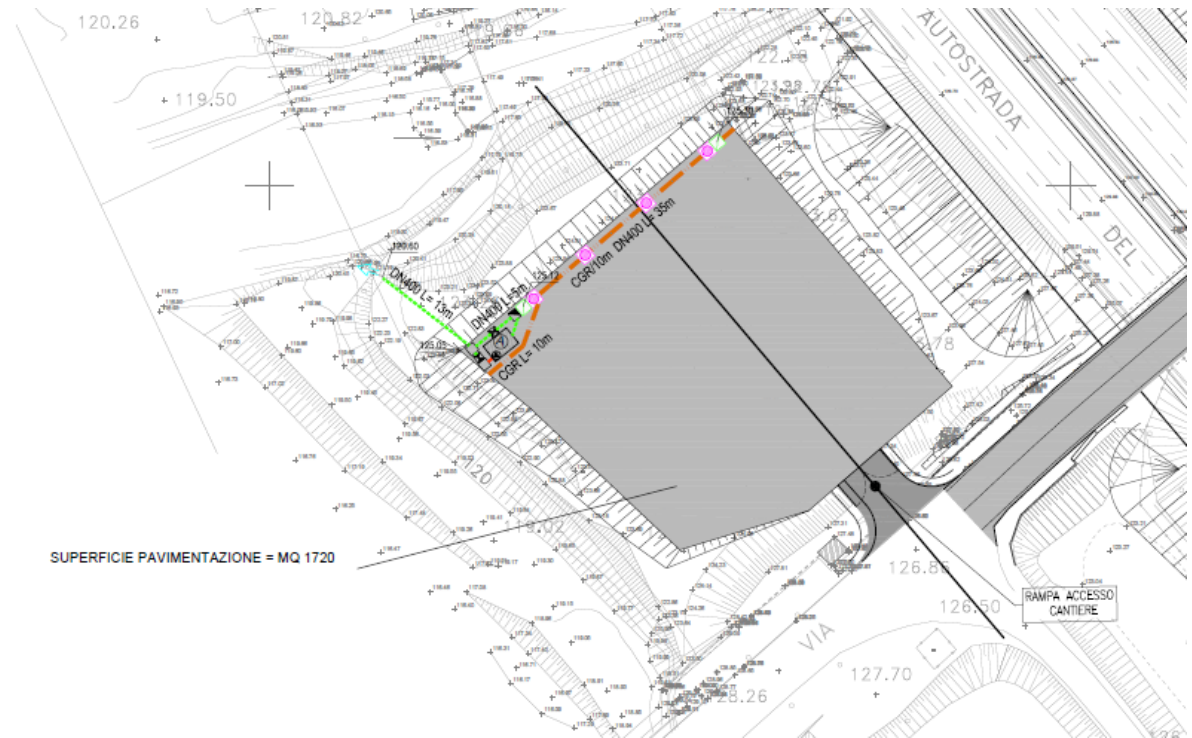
Planimetria reti idrauliche di AC01 – Area supporto progr. km 324+950
